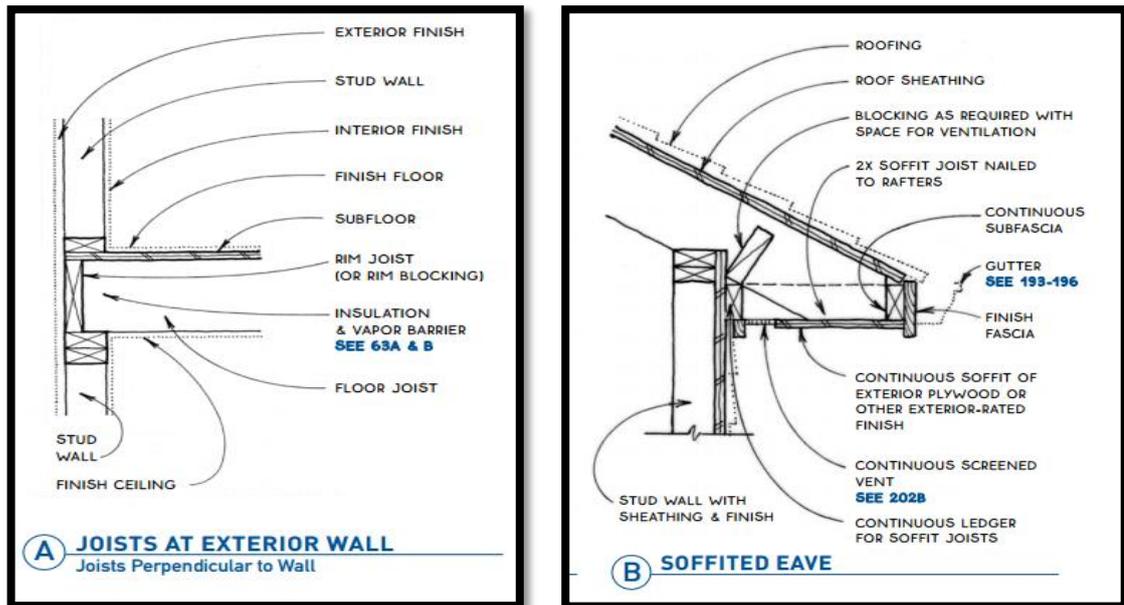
Detalle de paquete de Piso y techo. Carga Muerta. Fuente: Frame Construction.
